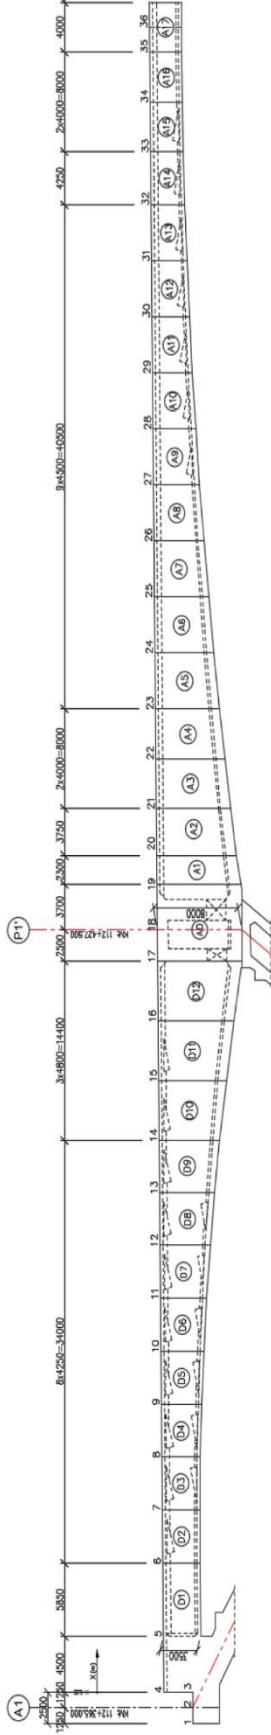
Çayırhan köprüsü plan ve profil görünümü
